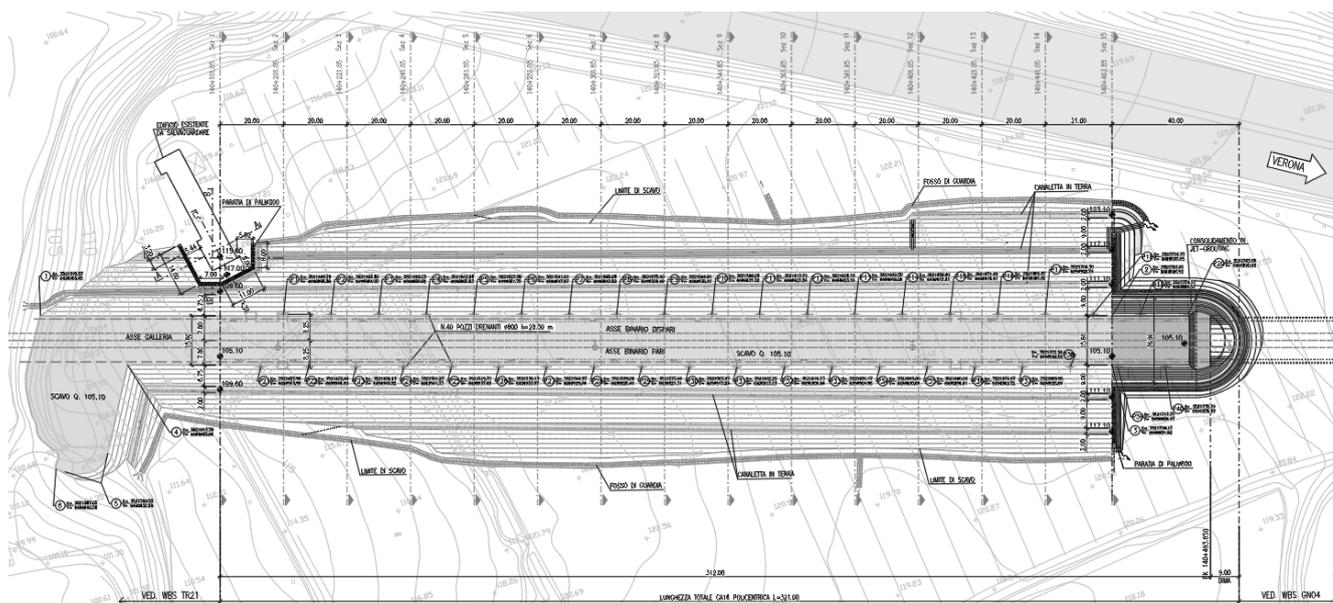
Planimetria di scavo galleria artificiale San Giorgio ovest.
